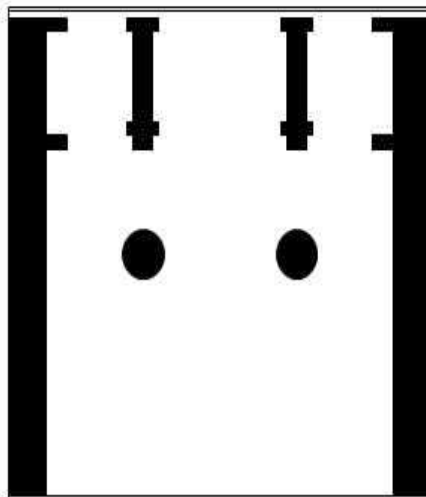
Pianta dei Piccoli propilei di Eleusi.
